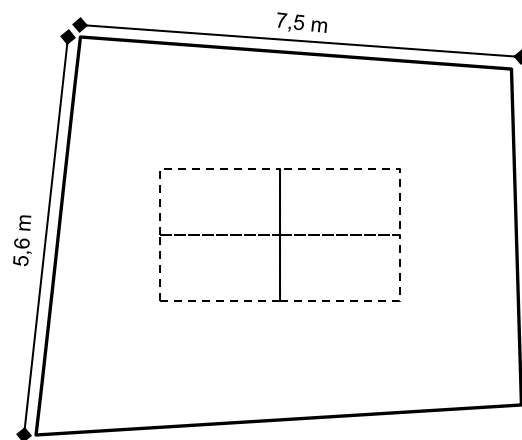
Planta esquemática da Câmara Reverberante R1 do Laboratório de Acústica do Departamento de Engenharia Civil da FEUP
